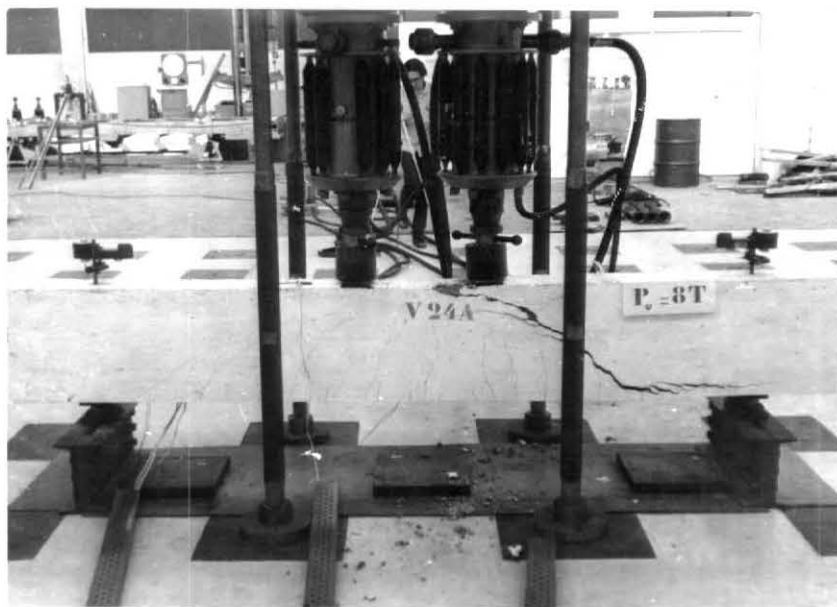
Vista geral da viga 24A ($a/d=2,4$) rompida por esmagamento do concreto na zona comprimida, associado com perda de ancoragem da armadura longitudinal.
